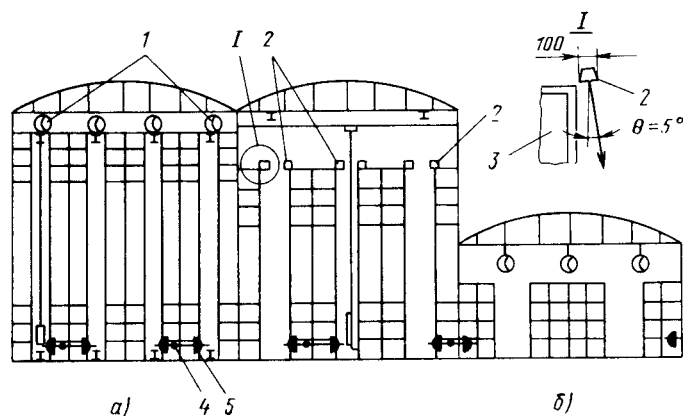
Освещение складов с кранами-штабелерами. Вариант установки светильников на конструкции стеллажей:
